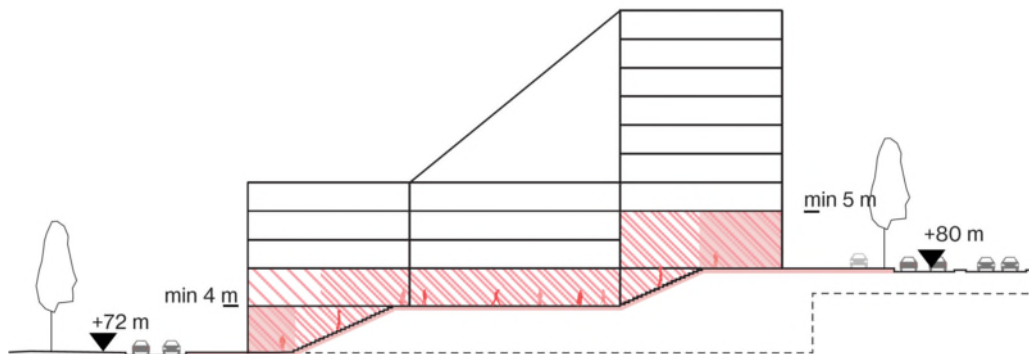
Différence de niveau entre le boulevard urbain et l'avenue de Beaulieu (ORG, 2018)
